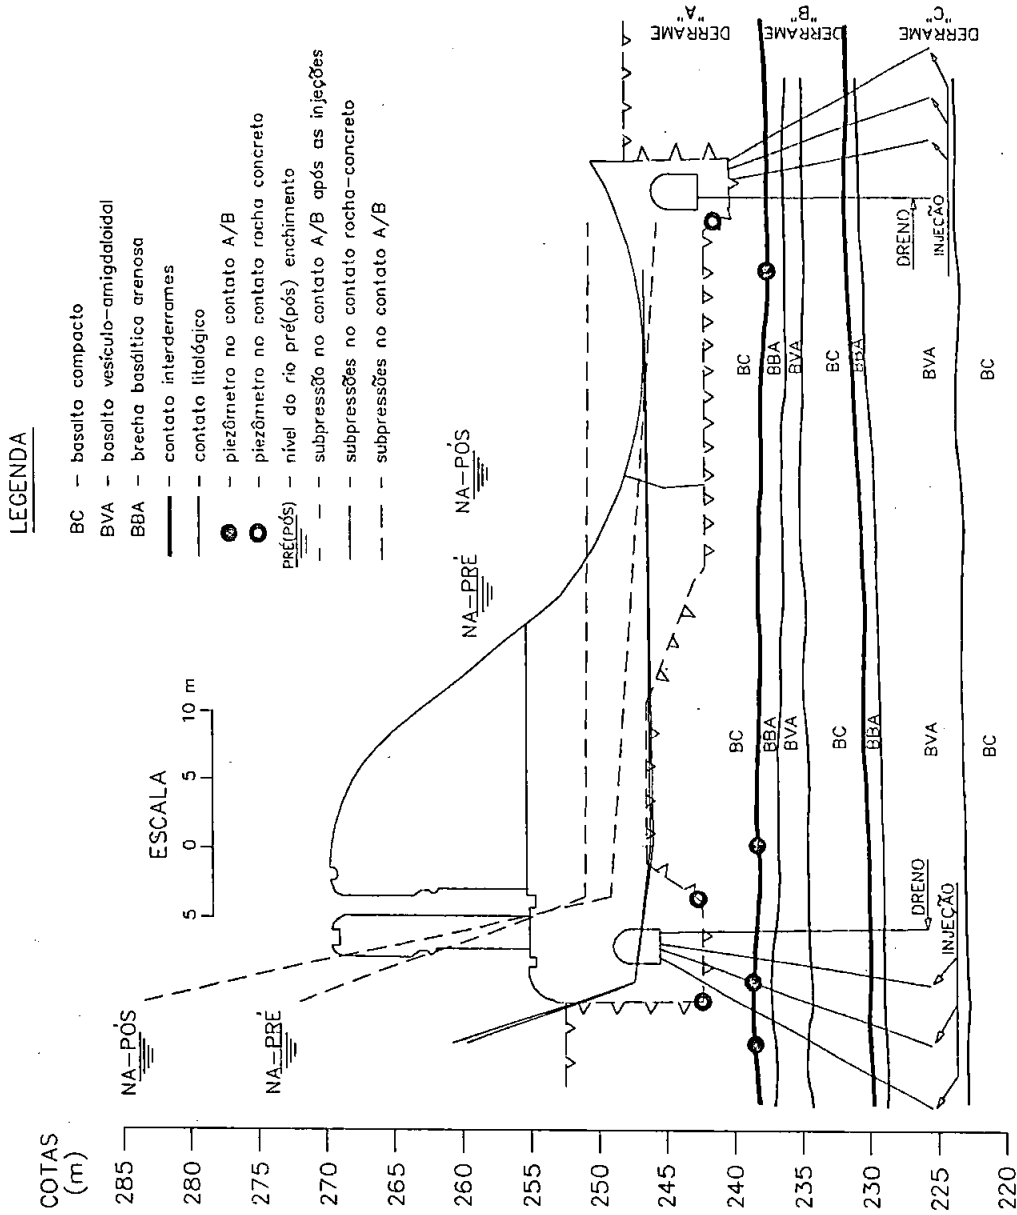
Seção piezométrica - vertedor - Bloco 73
